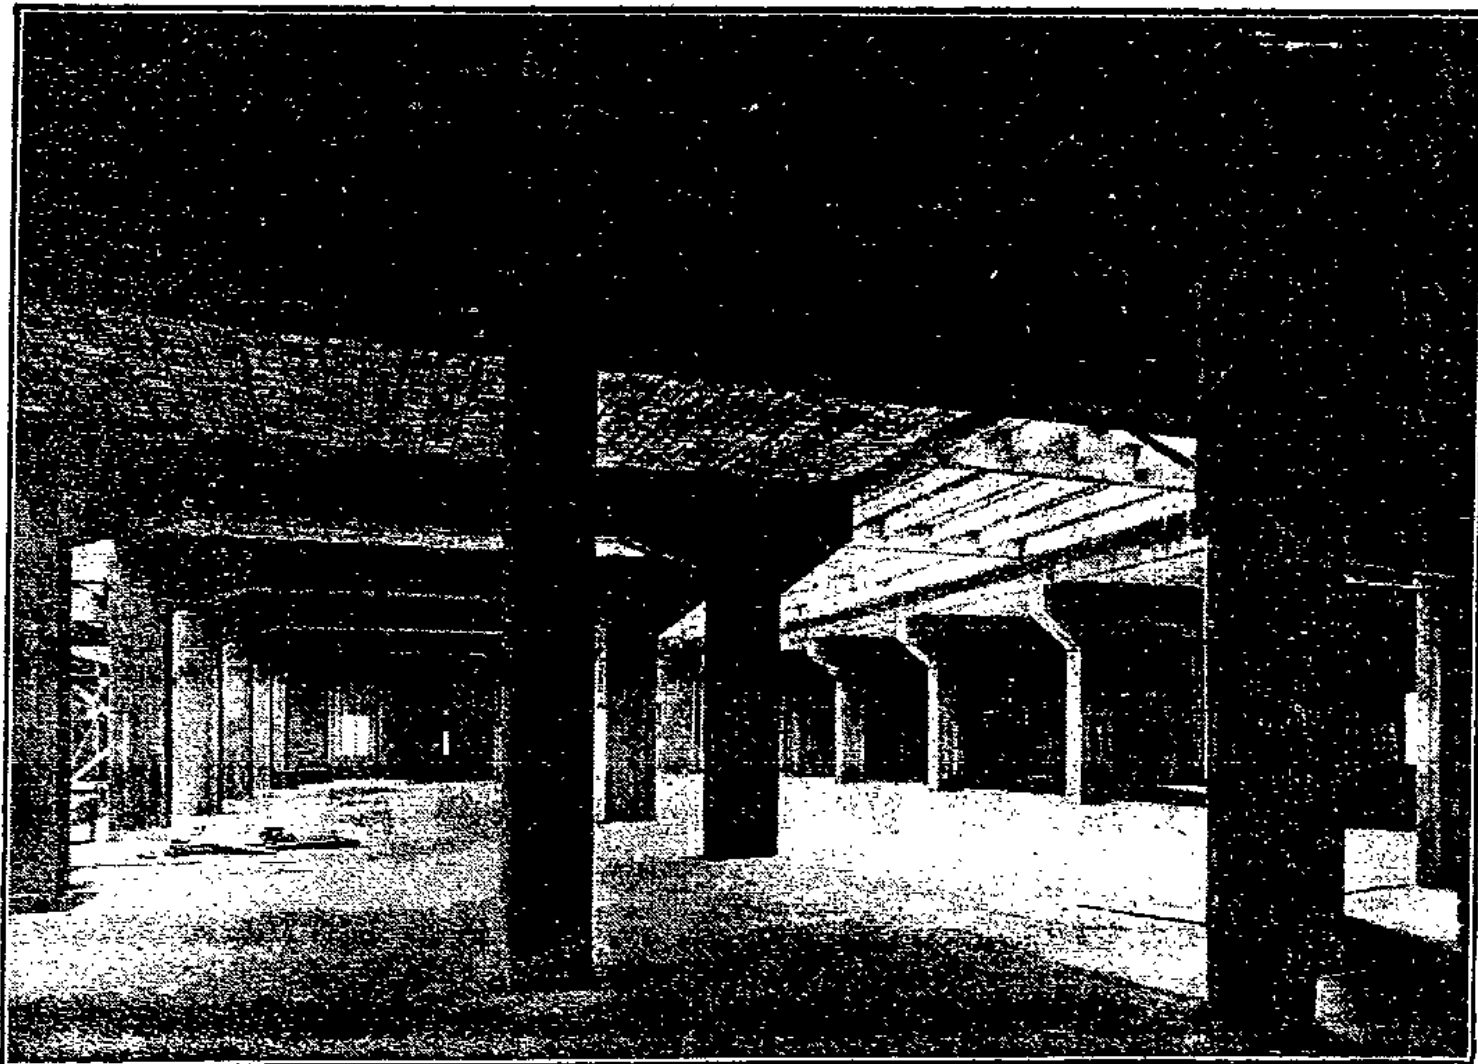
Große Schalterhalle mit anschließender Beamtenarbeitshalle
